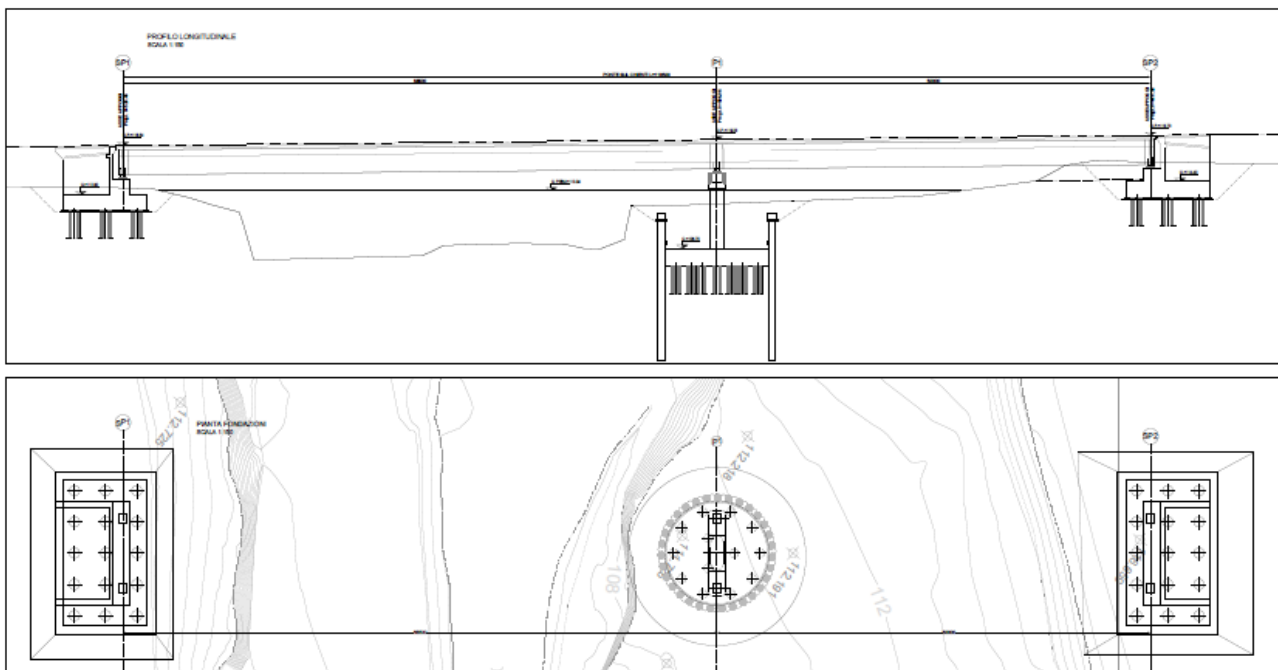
Profilo e pianta delle fondazioni del Ponte Chienti, comprensivi dell'opera provvisoria
